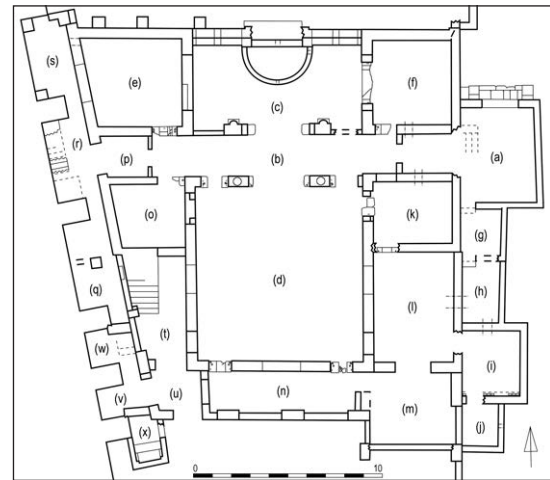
Domus accanto al Serapeo, Grundriss
